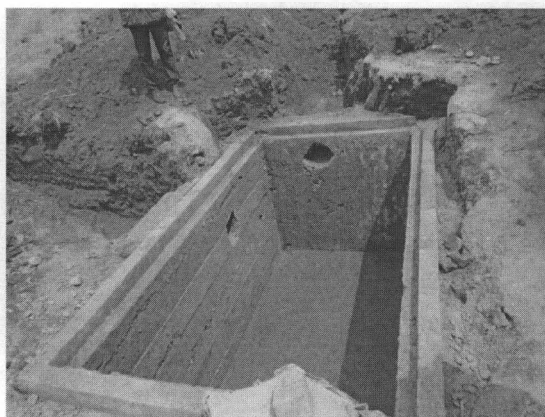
Poza de lixiviados para futuro proyecto de disposición final.
